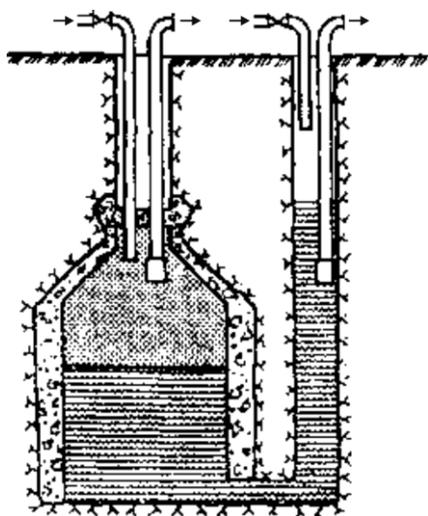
Подземное нефтехранилище в Наанали, Финляндия
